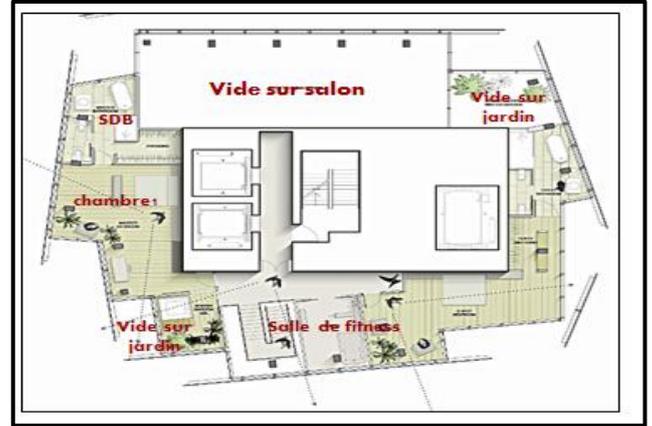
plan d'appartement 2<sup>ème</sup> étage
